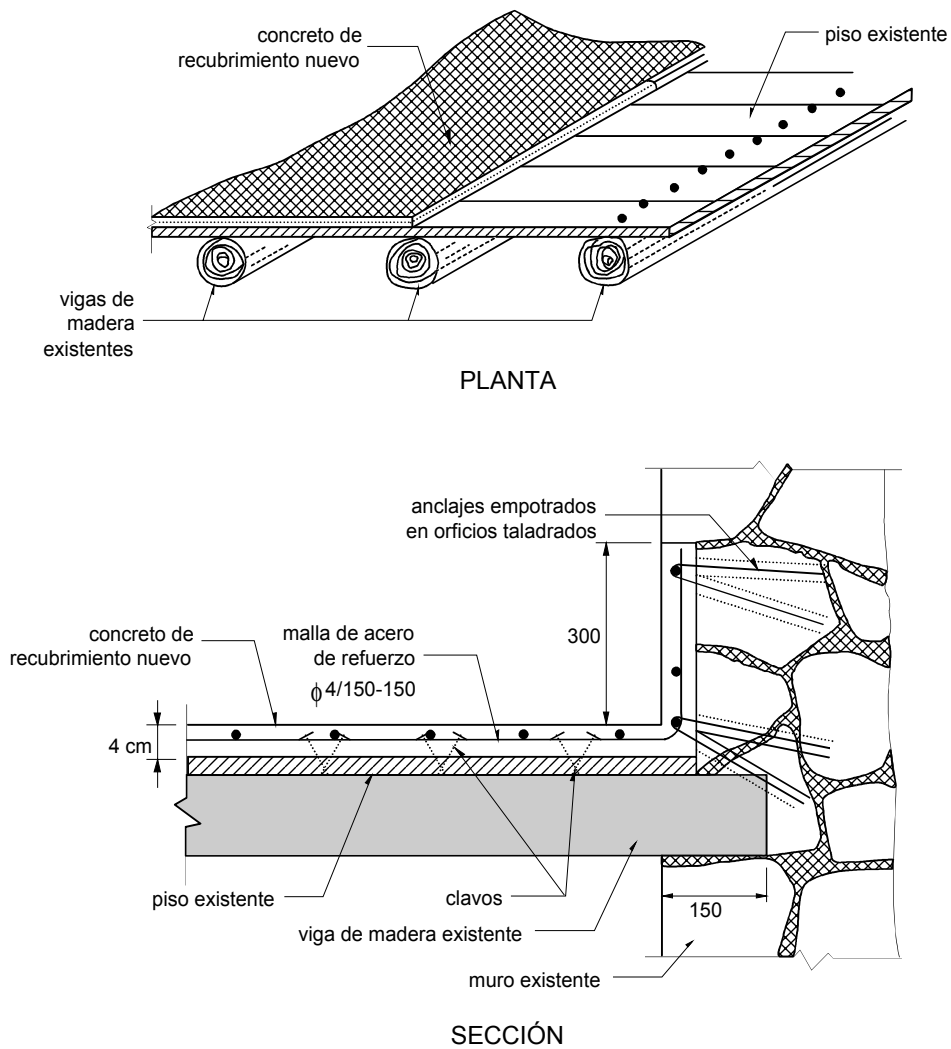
Incremento de la rigidez en el plano de sistemas de piso/techo usando madera o concreto
